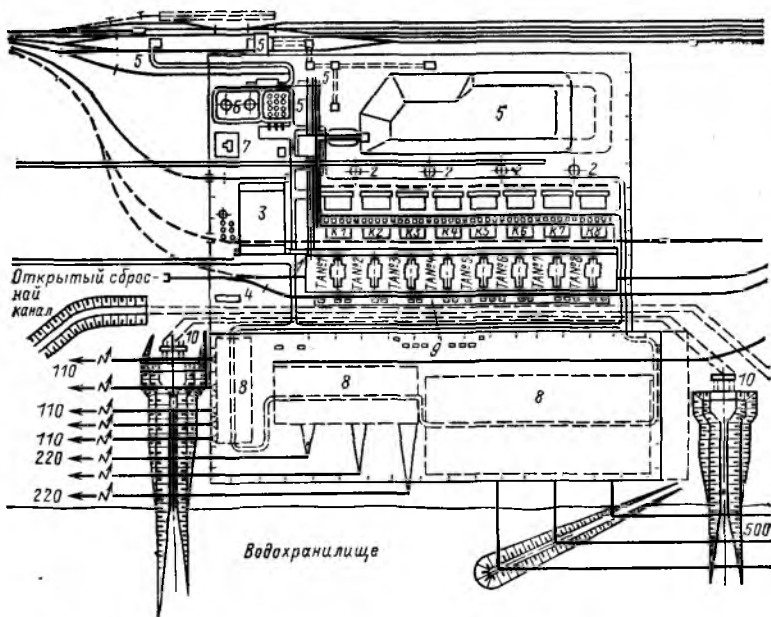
Схема генерального плана типовой КЭС 2400 МВт (вариант с размещением открытого распределительного устройства между водохранилищем и машинным залом):
